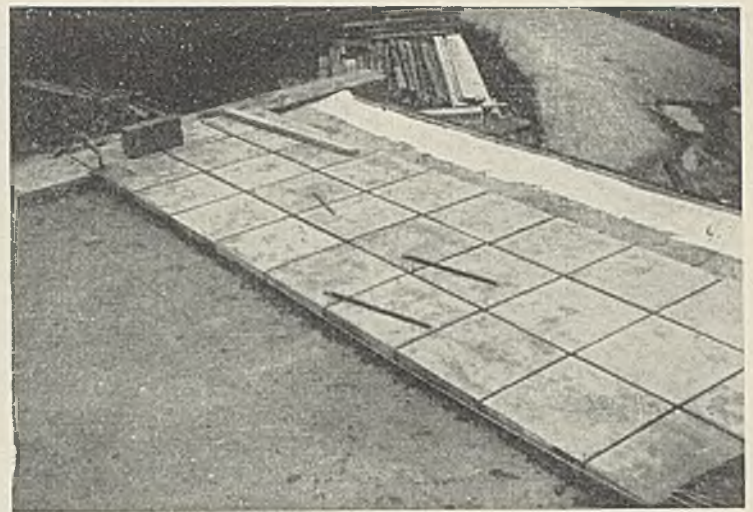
Fertige Abdeckung mit aufgebrachtem Mörtelbett und teilweise verlegten Preßbetonplatten. Der Abstand der Fugen wird durch vorübergehendes Einlegen besonderer Fugeneisen geregelt.
